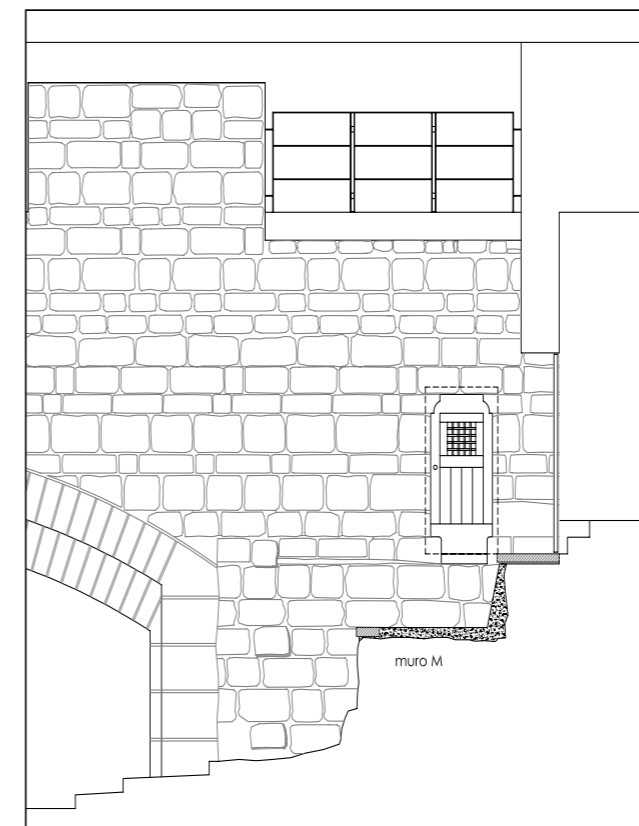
Sección del Proyecto de intervención sobre la batería de Santa Ana y la muralla de la Fuente de Peñíscola. El muro localizado en la base debió corresponder a la estructura que se hizo para el terraplenado de la zona. (MJB 2000).
